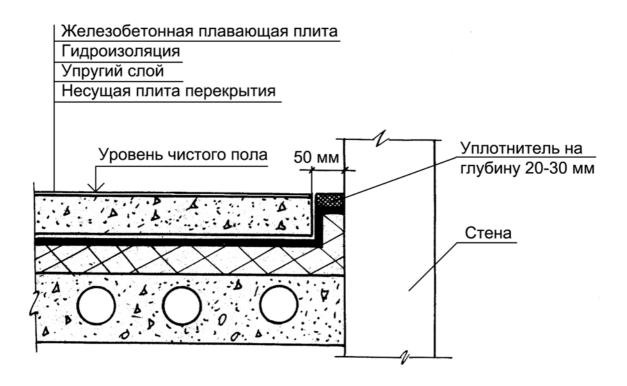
Конструкция пола на упругом основании и его стыка со стеной
